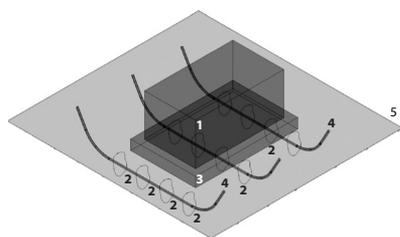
Схема усиления контактной зоны основание – фундамент методом цементации при горизонтально ориентированной проходке вдоль свайных фундаментов (рисунок авторов)
